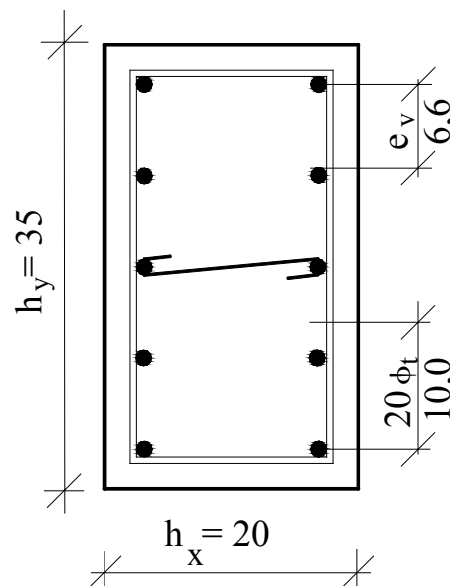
Detalhamento da armadura na seção transversal para 10 ϕ 12,5 mm.
